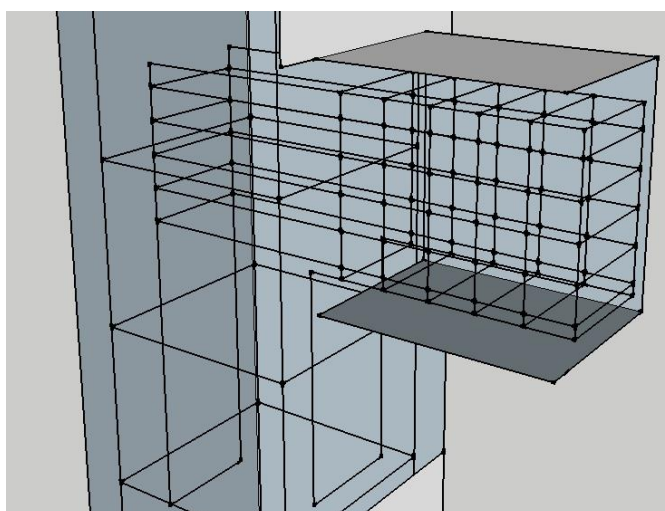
Detalhe das armaduras conforme NBR 9062:2017.
